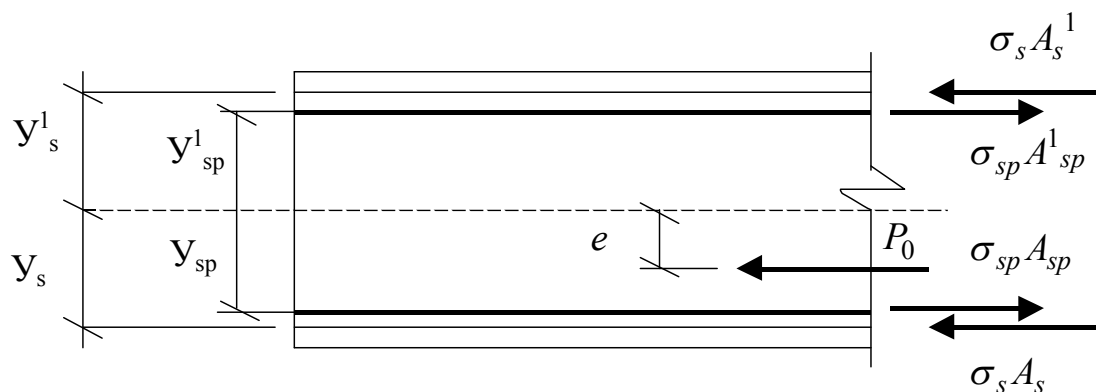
Схема распределения усилий обжатия бетона
